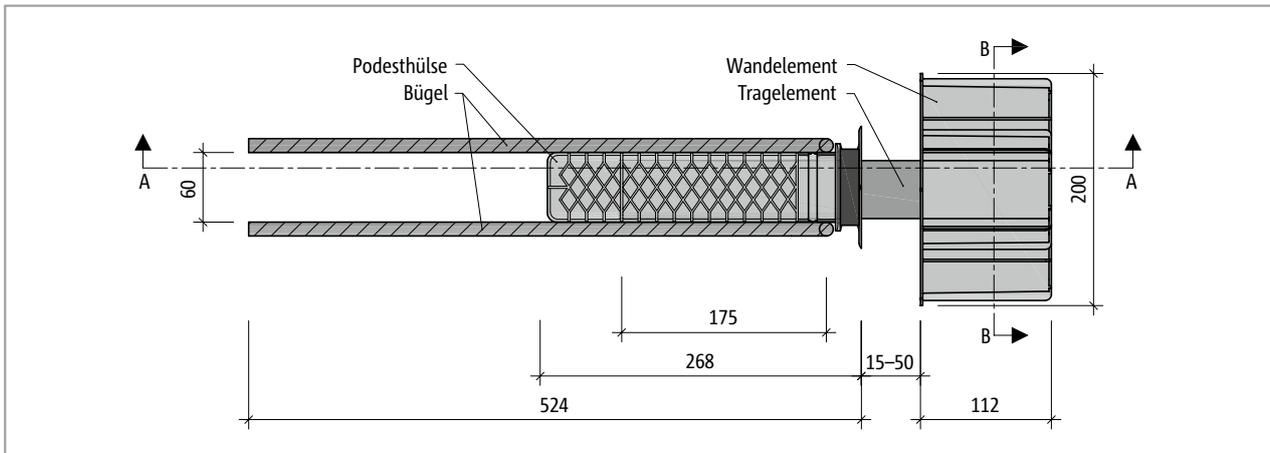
Schöck Tronsole® Typ P: Produktgrundriss
